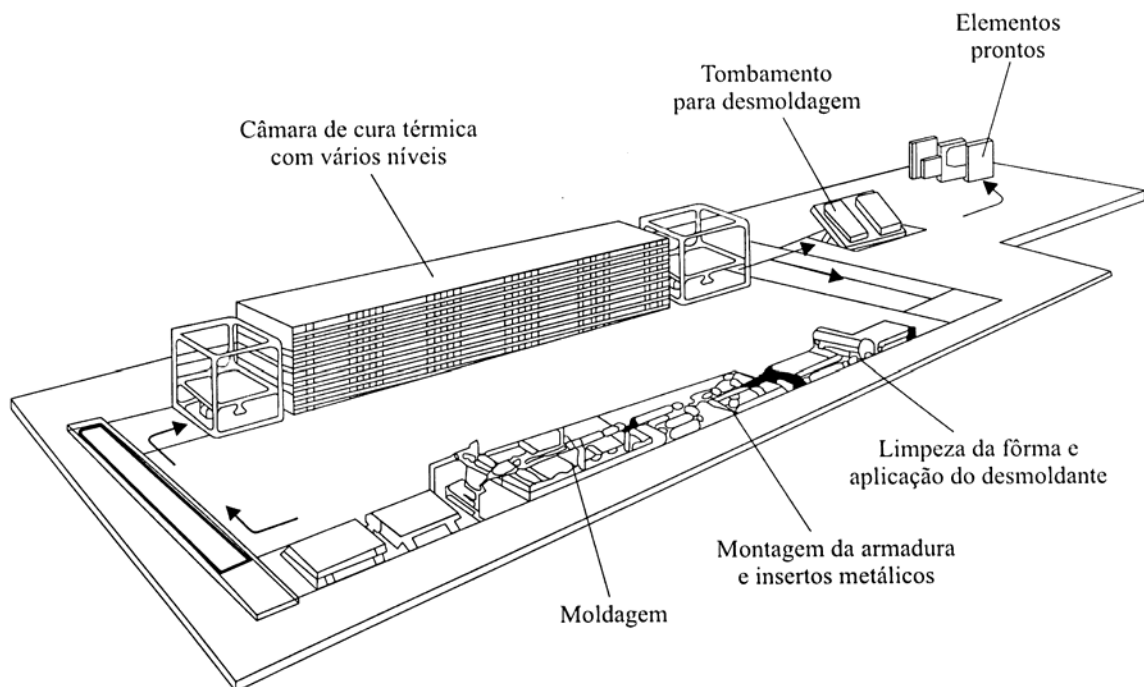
Exemplo de execução de painéis com fôrma móvel
